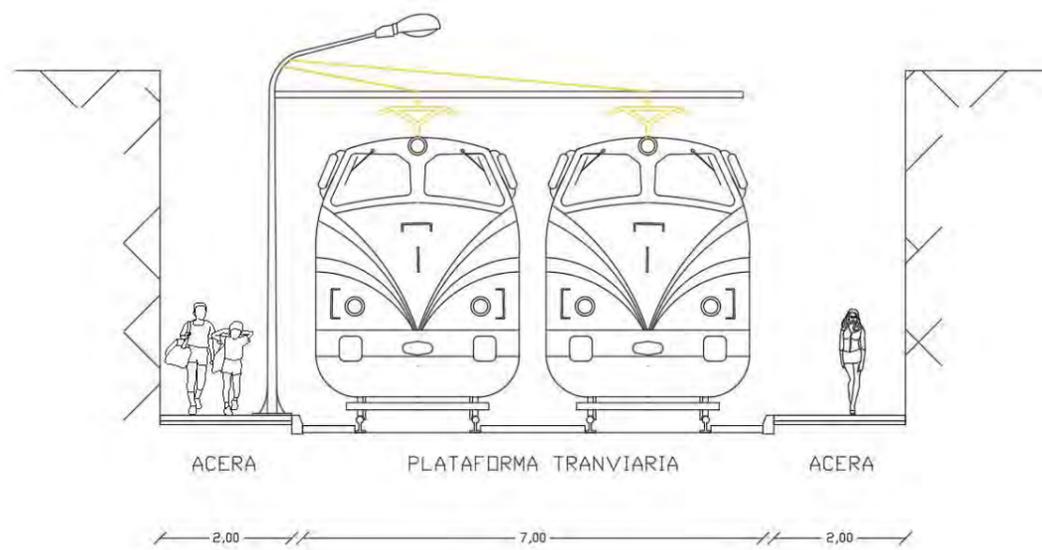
Sección tipo B (cotas en m). Fuente: Elaboración propia
